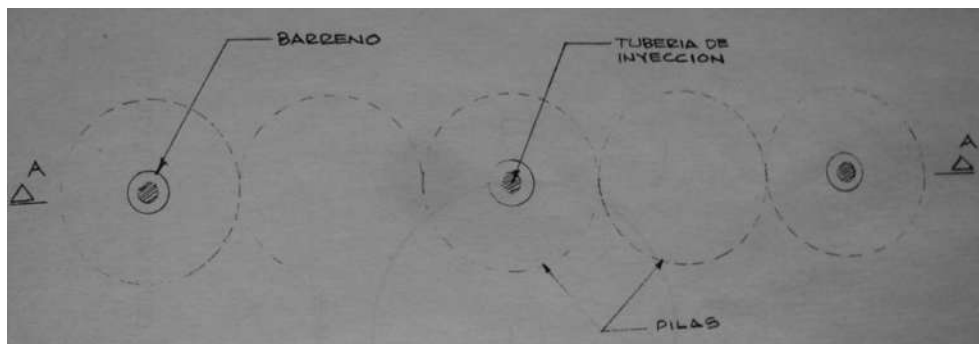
Columnas inyectadas (PLANTA)
